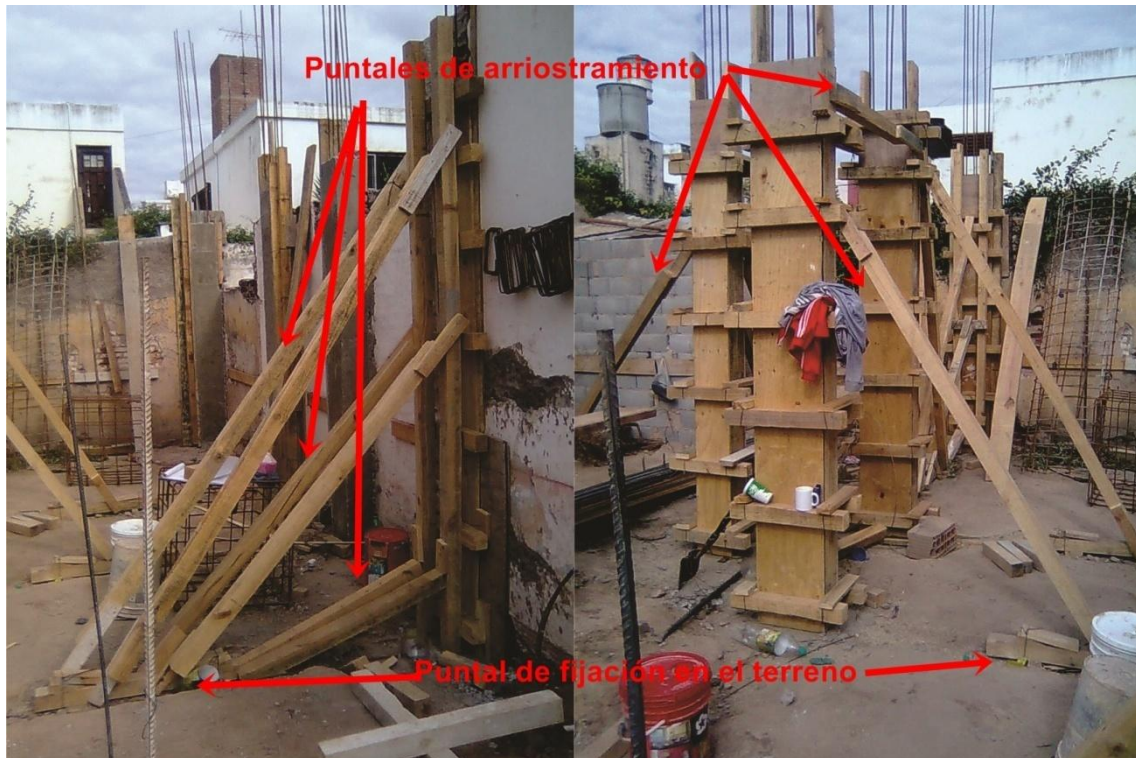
\_Encofrado de columna Lateral y conjunto de columnas Centrales.
